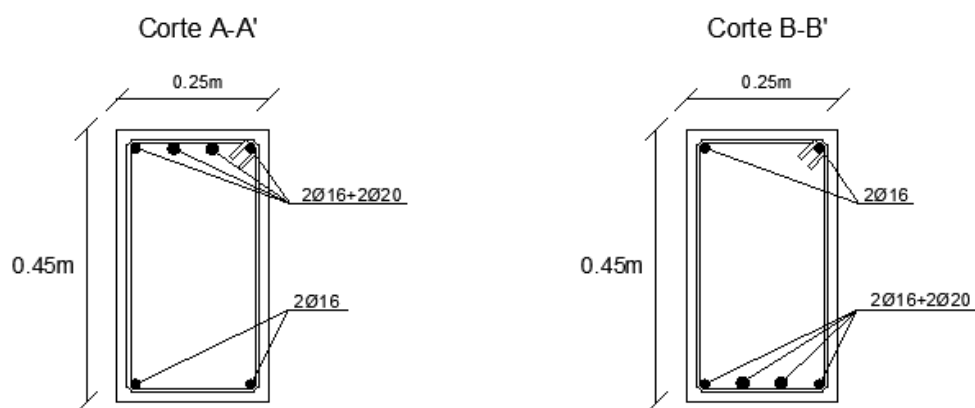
Secção transversal da viga na zona de momento máximo negativo e positivo
